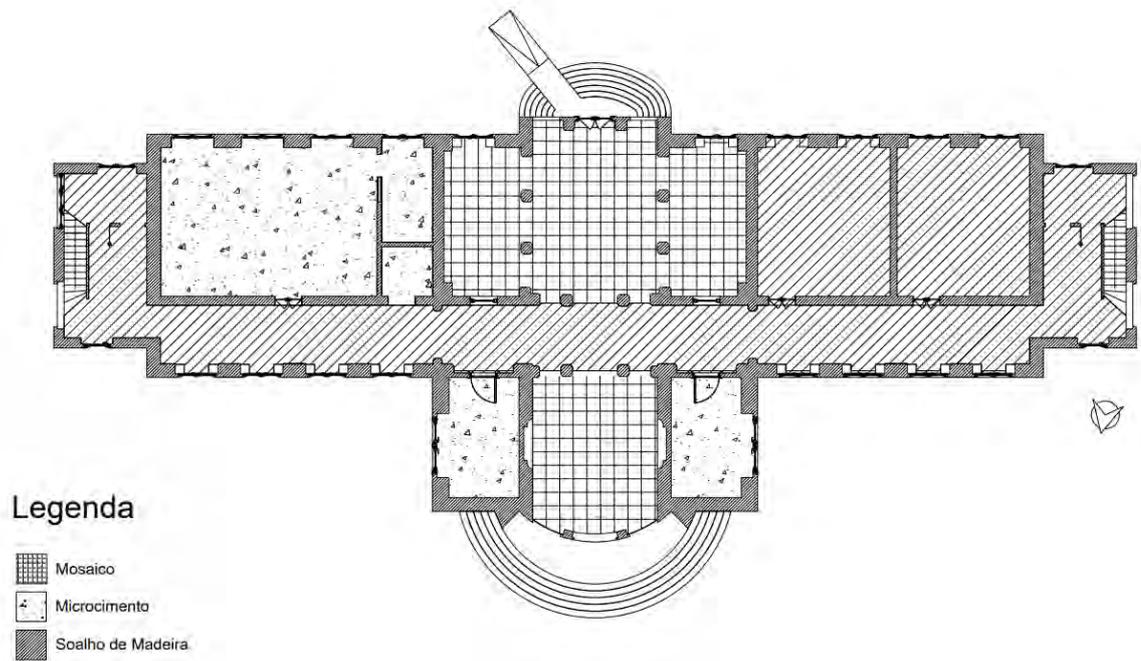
Planta de Pavimento Fonte: 2023, Maria Luís Martins
